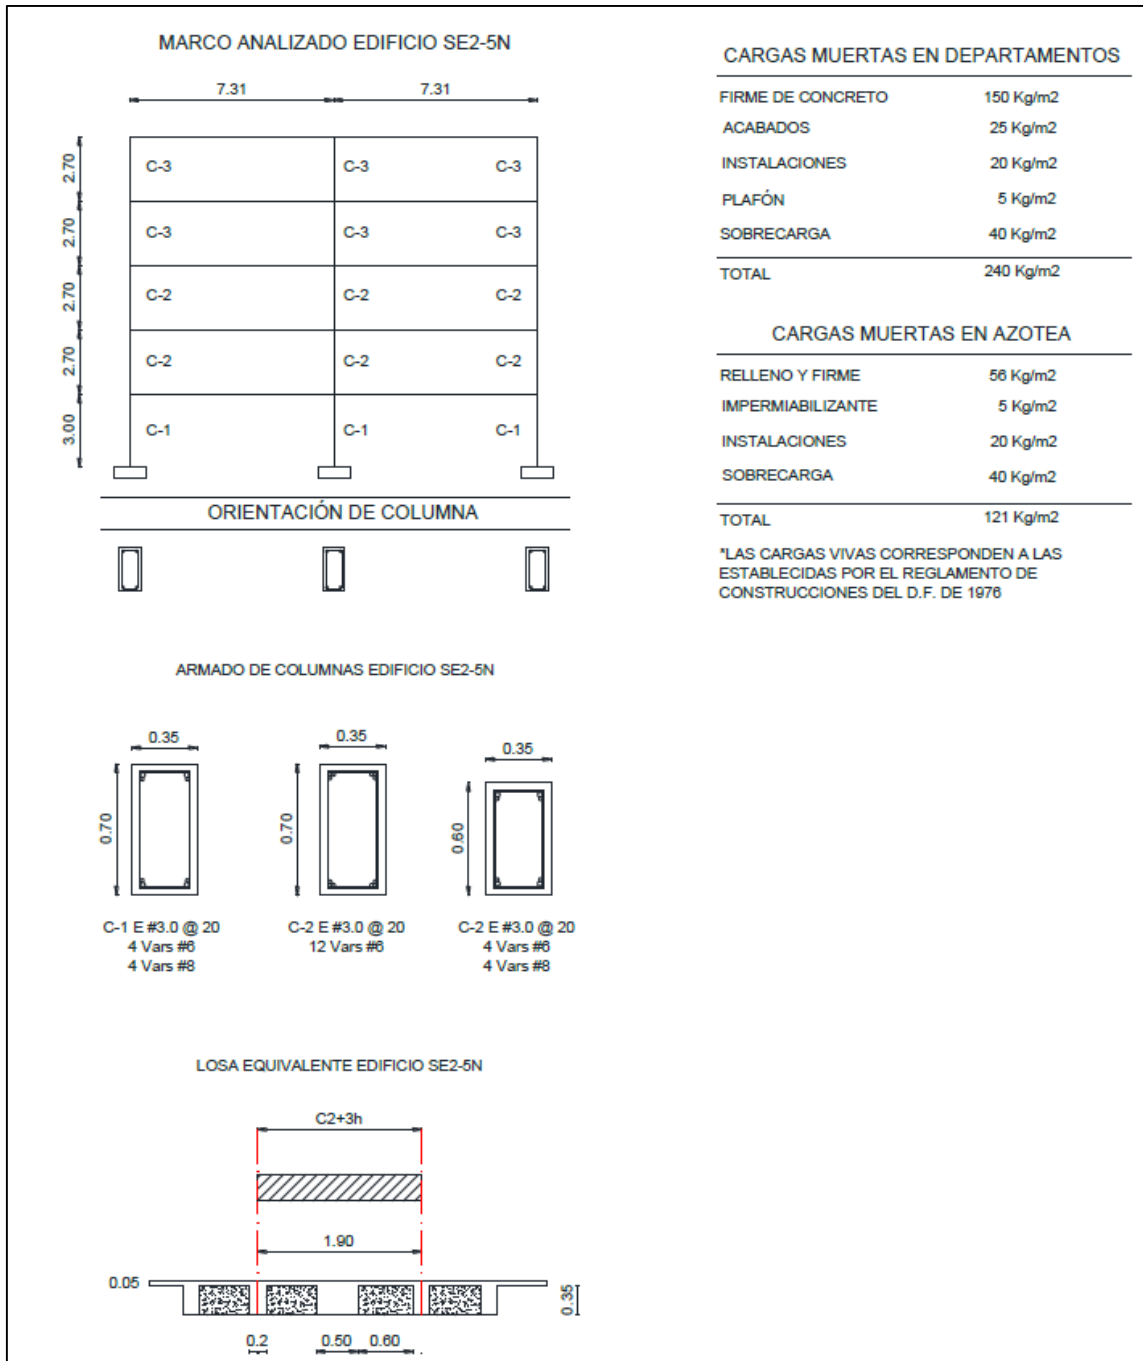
Detalles estructurales y cargas del edificio SE2-5N usadas en el análisis no-lineal.
